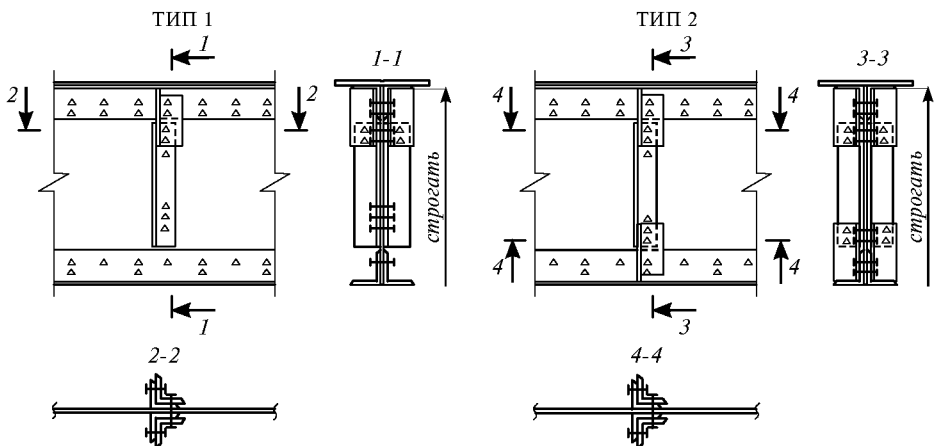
а. Ребра жесткости на подкрановых балках с соединениями на высокопрочных болтах: крепление ребер к стенке балки без прокладок
